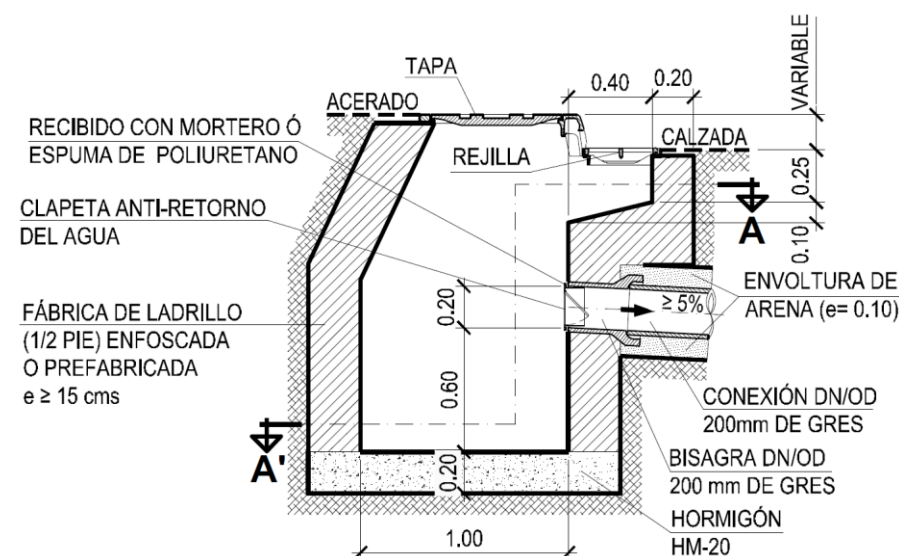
1 Sección tipo de Sumidero Mixto Rejilla-Buzón instalado en la calle Isaac Peral. Fuente: Instrucciones Técnicas para las Redes de saneamiento de EMASESA. Detalle Nº SA-05.
